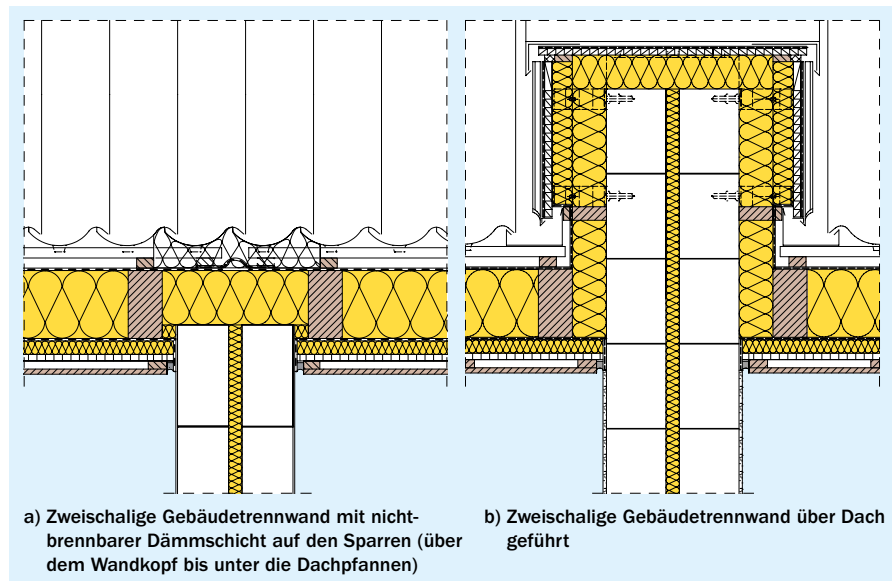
Gebäudeabschlusswand aus Kalksandstein-Mauerwerk im Dachbereich
